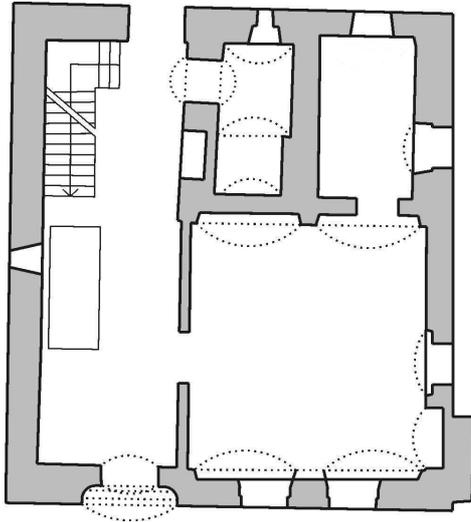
Rekonstruktion des Erdgeschoßgrundrisses vor 1850
